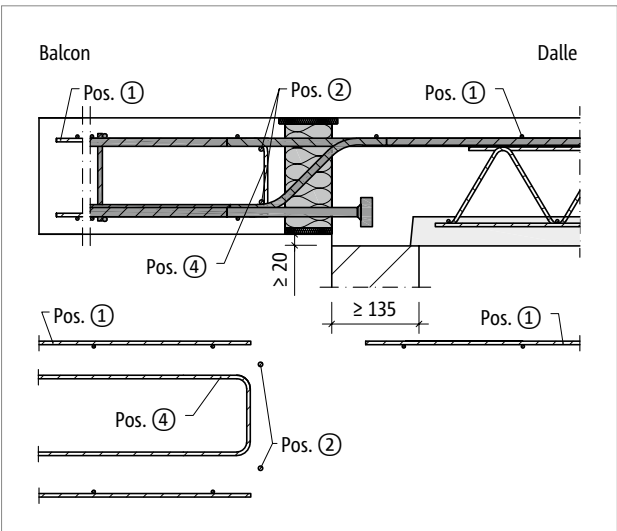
Schöck Isokorb® T type K-T-M13 : renforcement sur site pour support
